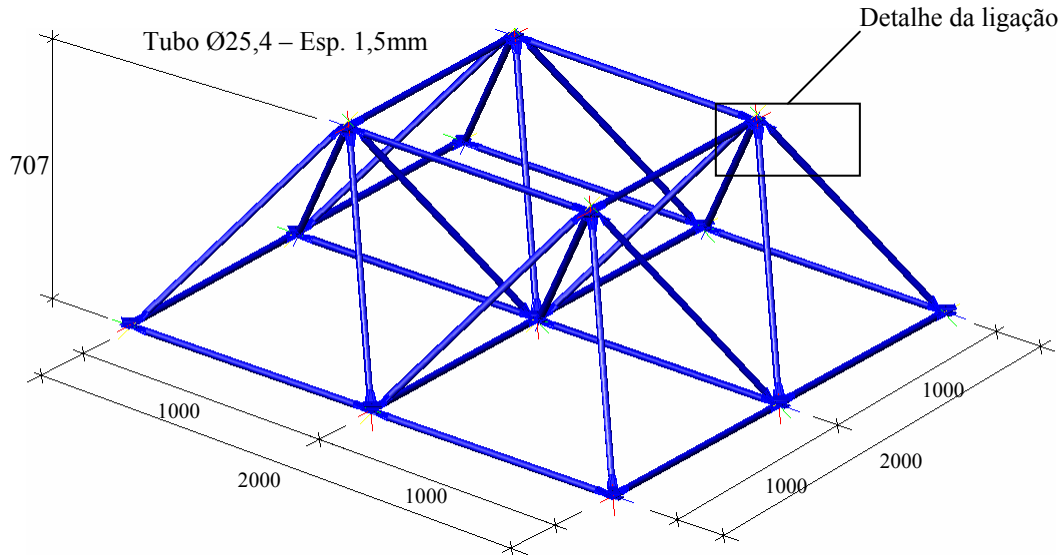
Modelo da estrutura treliçada tridimensional adotada, cotas em milímetro
